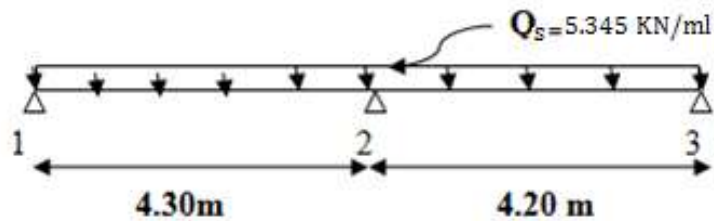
Schéma statique de la poutrelle II à l'ELS.
